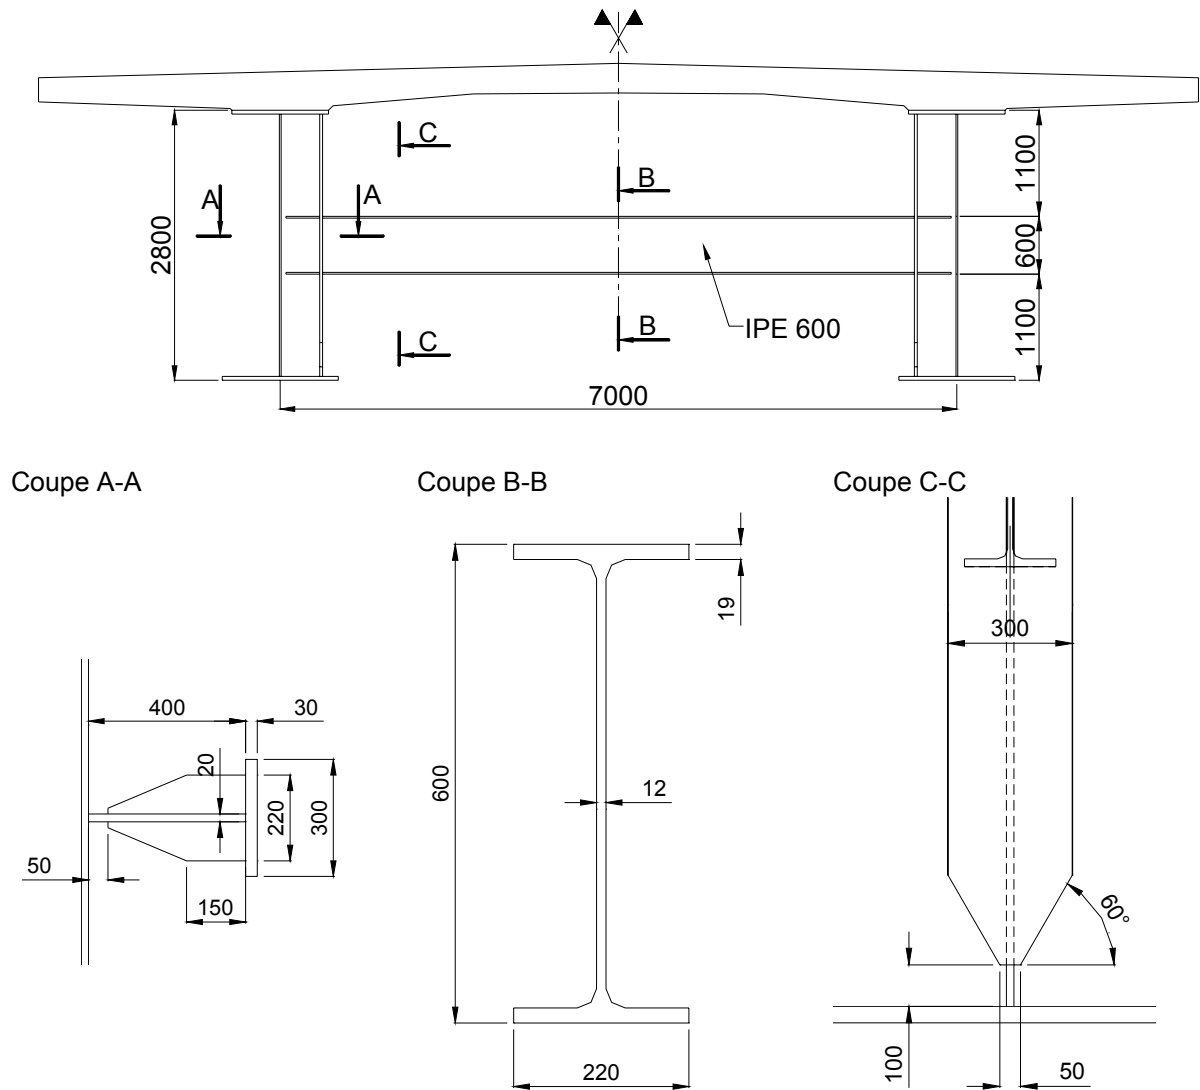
4 : Détails constructifs des éléments transversaux en travée
